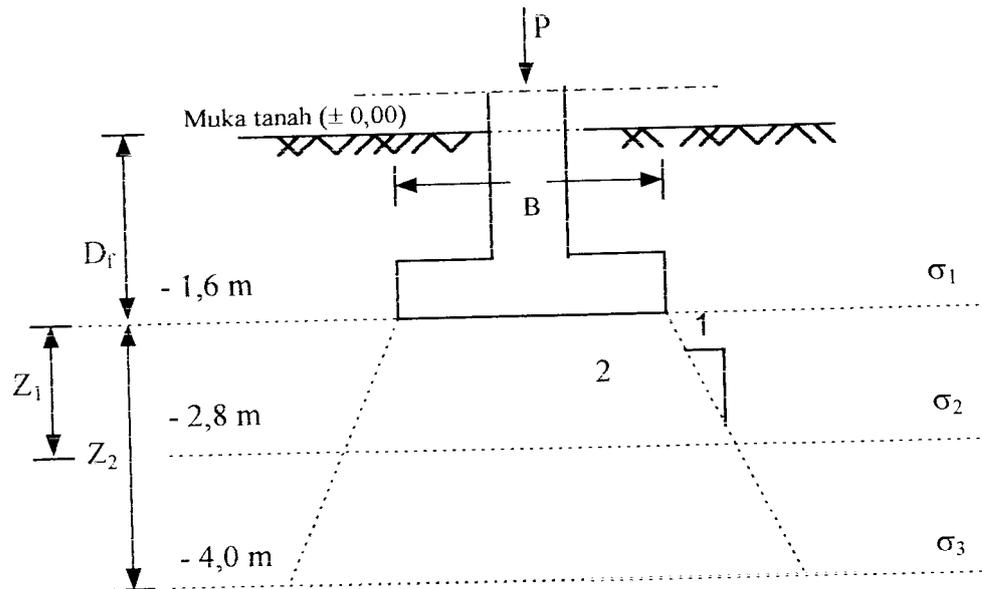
Daerah keruntuhan bidang geser pondasi
